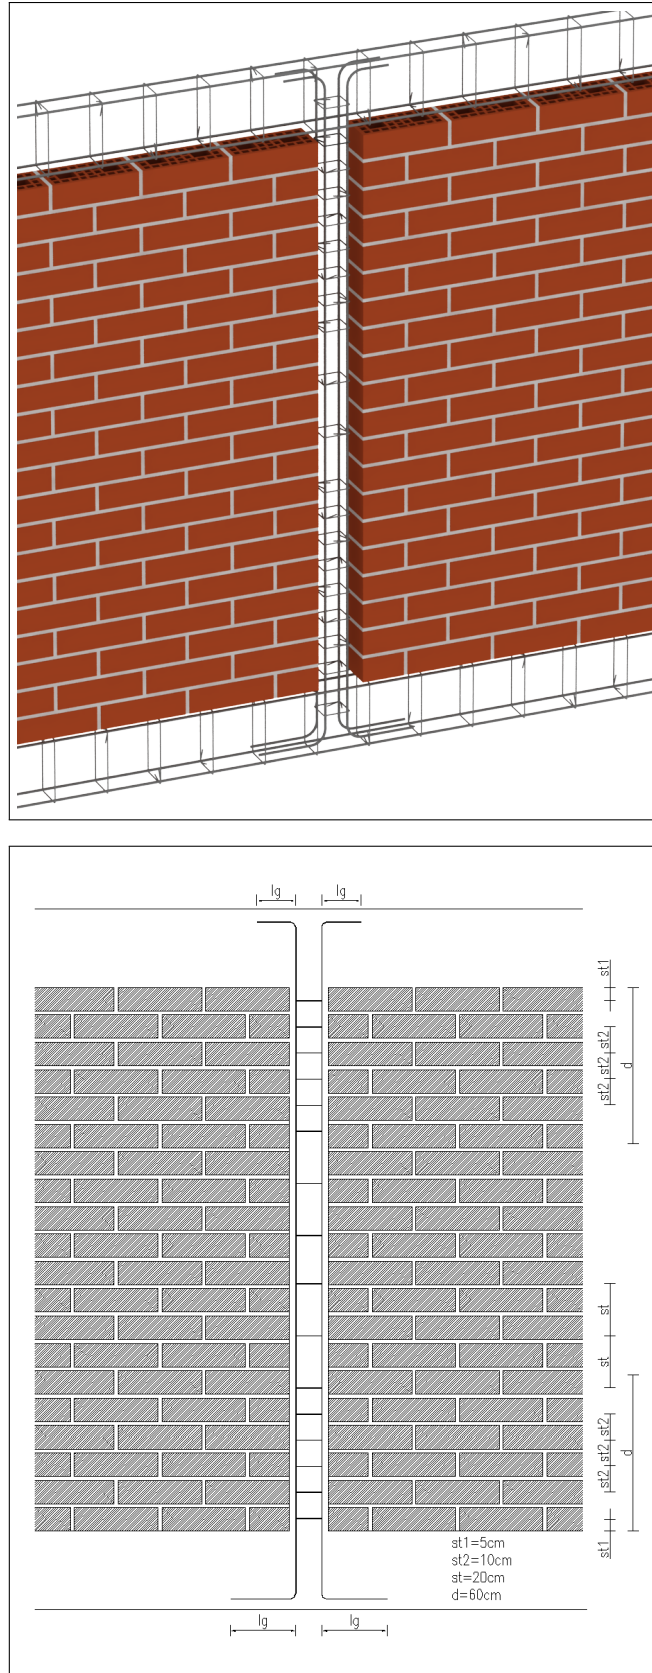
Separación de los estribos de refuerzo en las zonas críticas de un pilar de confinamiento
